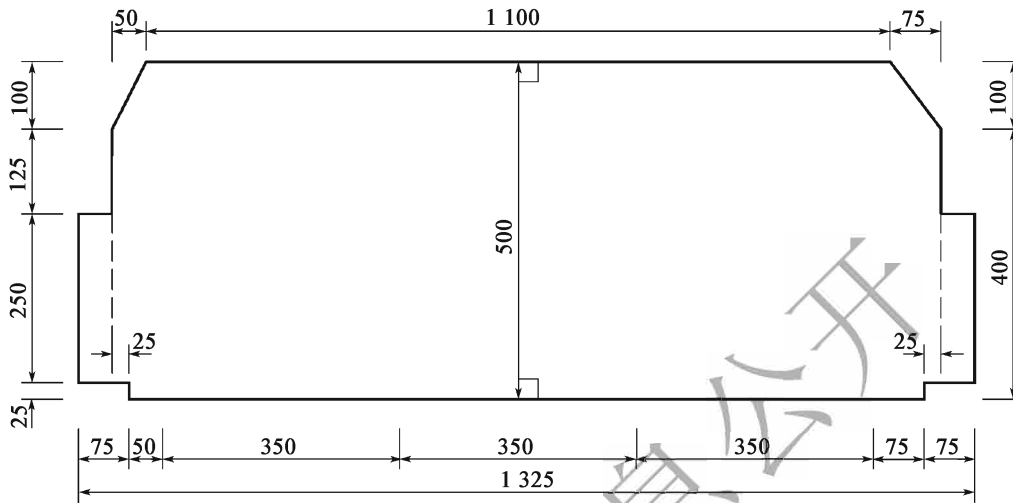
Dégagement de construction du tunnel routier de première classe à trois voies (60km/h) (unité: cm)
